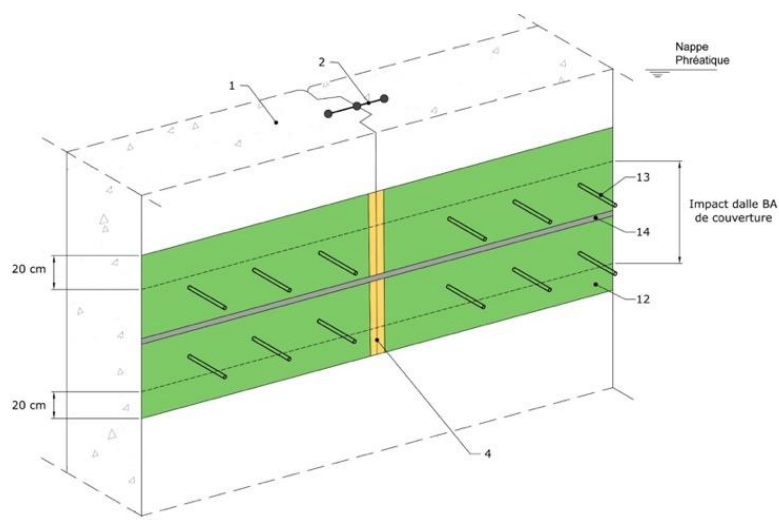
Étanchéité SEL-A sous dalle de couverture située sous la tête d'une paroi moulée et sous nappe phréatique
